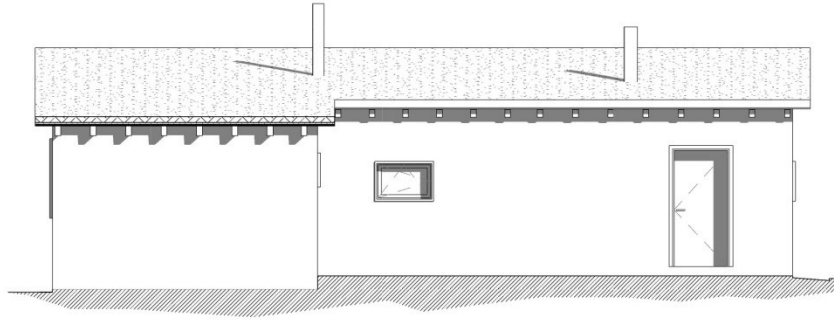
Alzado entrada vivienda (sin escala). 2016. Creación.
